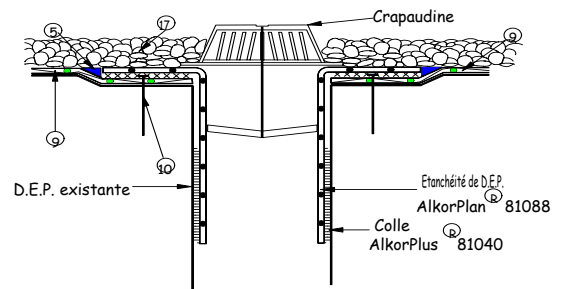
Etanchéité préfabriquée de descentes d'eau pluviales
